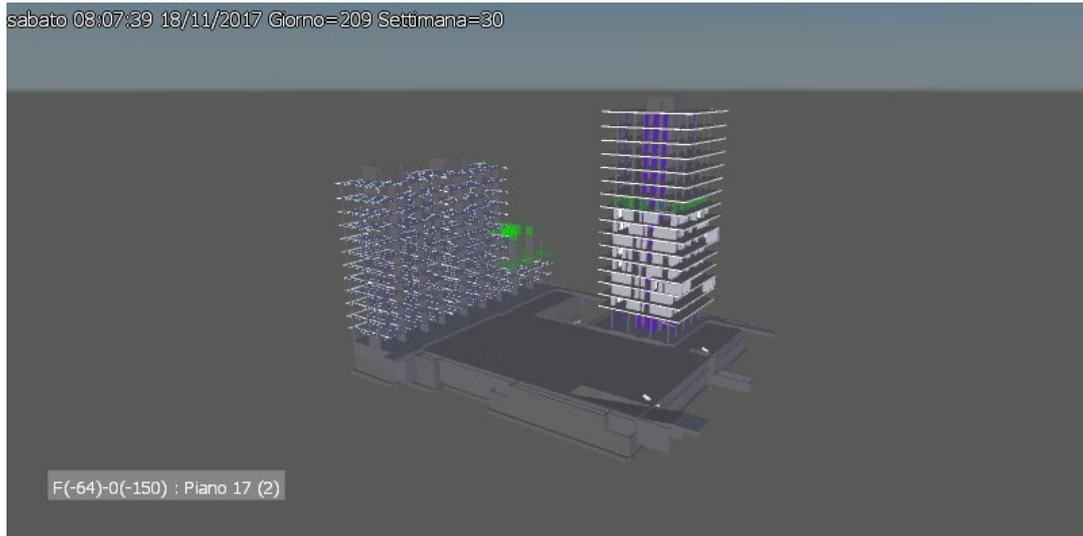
Simulazione 4D - Chiusure esterne Tower ed Elevazione vano scala D Garden
